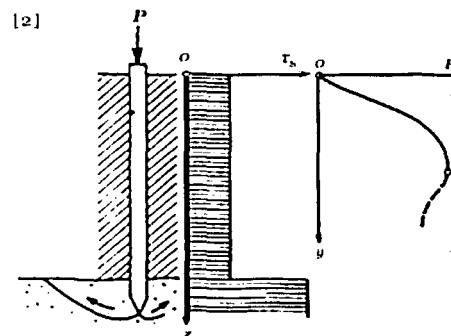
A. Mecanismos de falla en pilotes [5]
